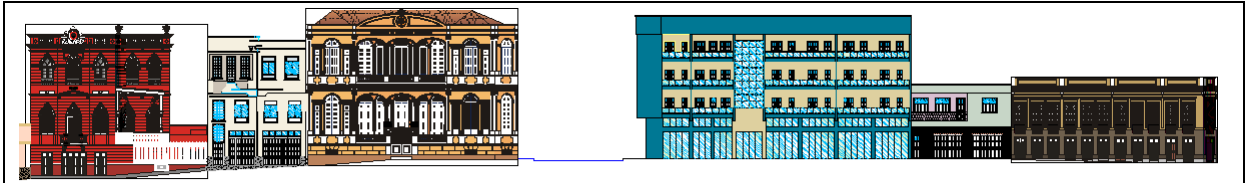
Fachadas Revitalizadas - Trecho 02 (quadras 36 e 31) da Rua Cel Sérgio Pessoa, com propostas para as fachadas.
